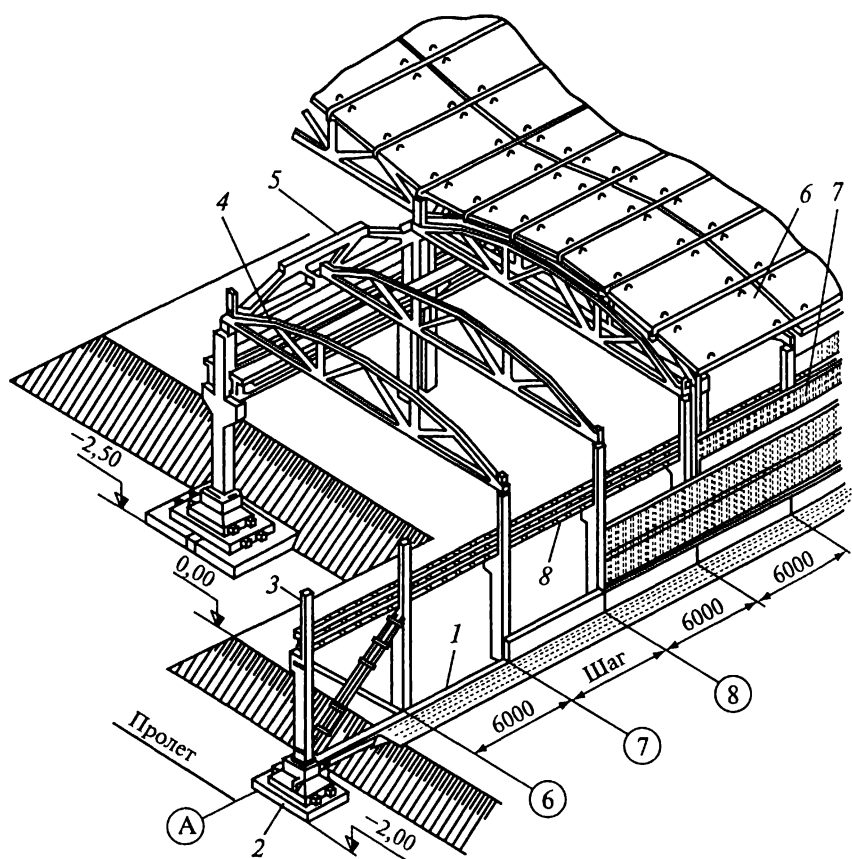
Конструктивные элементы одноэтажного промышленного здания: 1, 6 — панели; 2 — фундамент; 3 — колонна; 4 — подстропильная ферма; 5 — стропильная ферма; 7 — подкрановая балка; 8 — фундаментная балка
